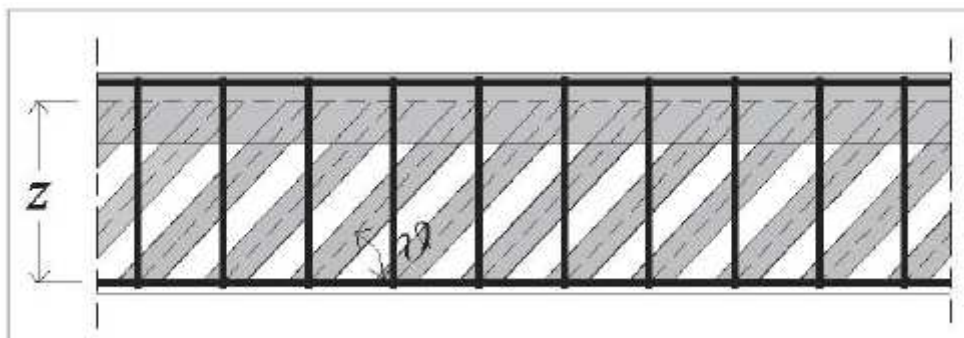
Modello a traliccio con struttura d'anima tradizionale
